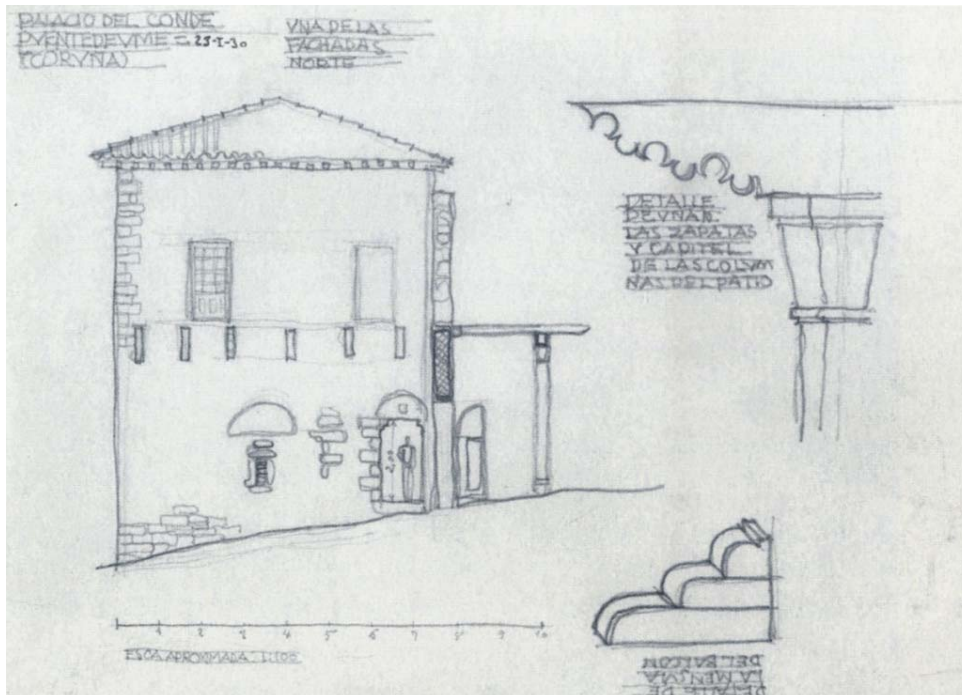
Fachada norte del volumen este, y detalle de las zapatas y capitel de las columnas del patio. Enero de 1930.
